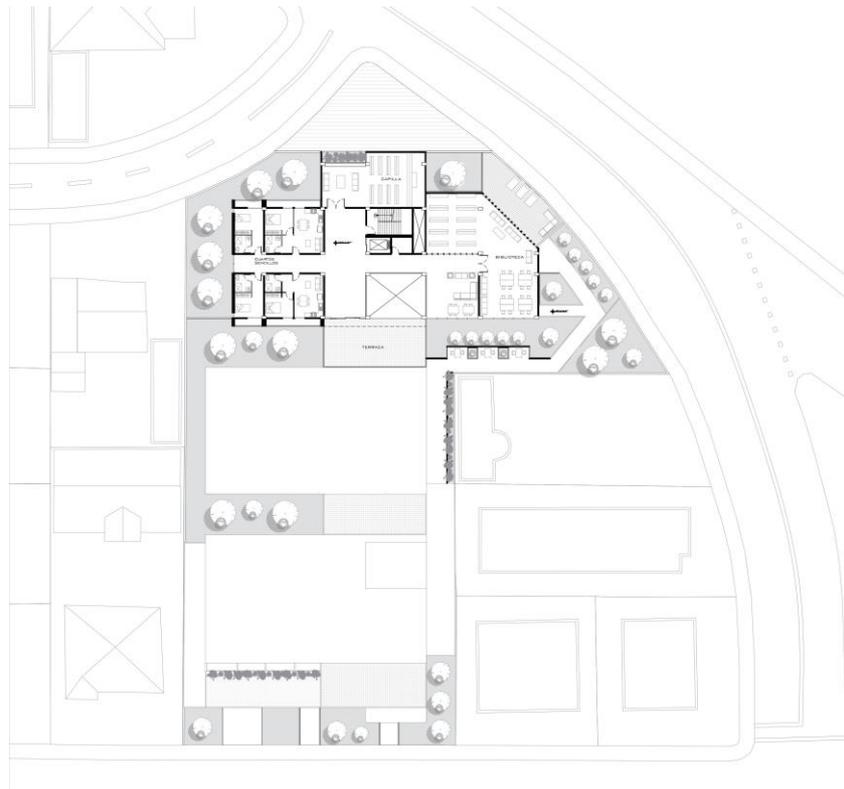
Planimetría: Planta Alta 4 N+ 12.96
